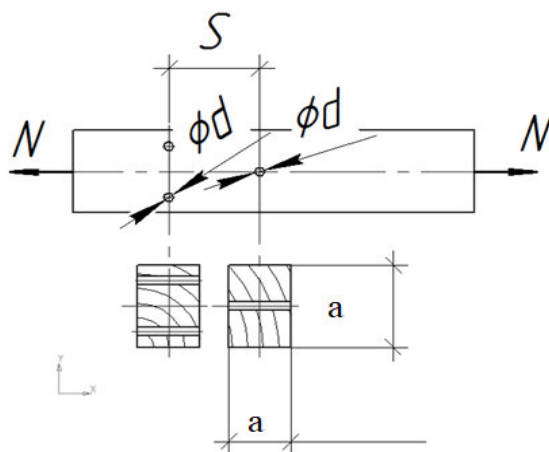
Расчётная схема к самостоятельному расчёту на растяжение деревянного элемента
